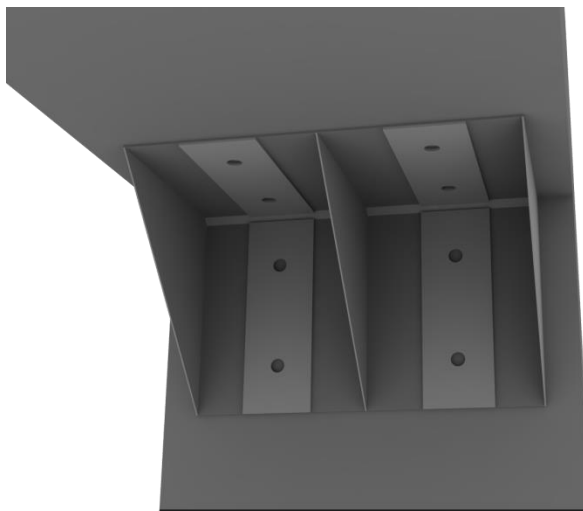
Intervenção para a ligação entre viga e pilar
